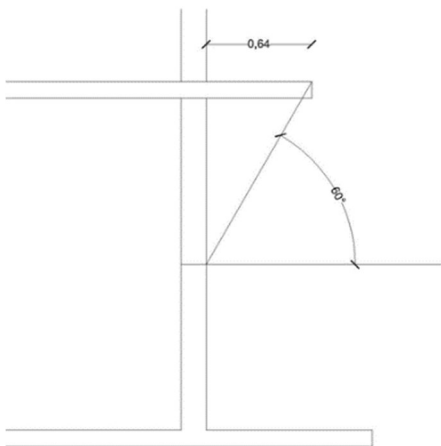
Alzado para el cálculo del protector considerando el ángulo de incidencia horizontal
